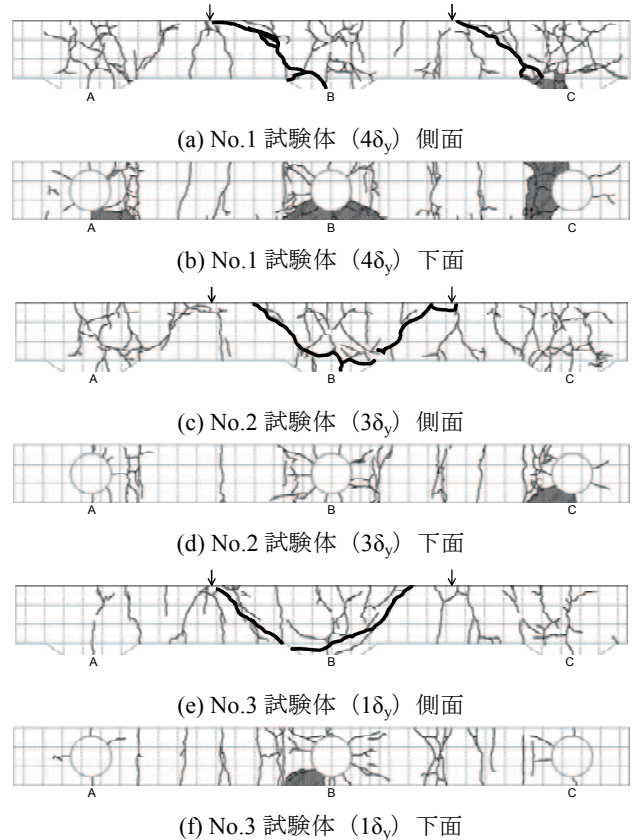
上部工のひび割れ図（静的載荷終了後）
